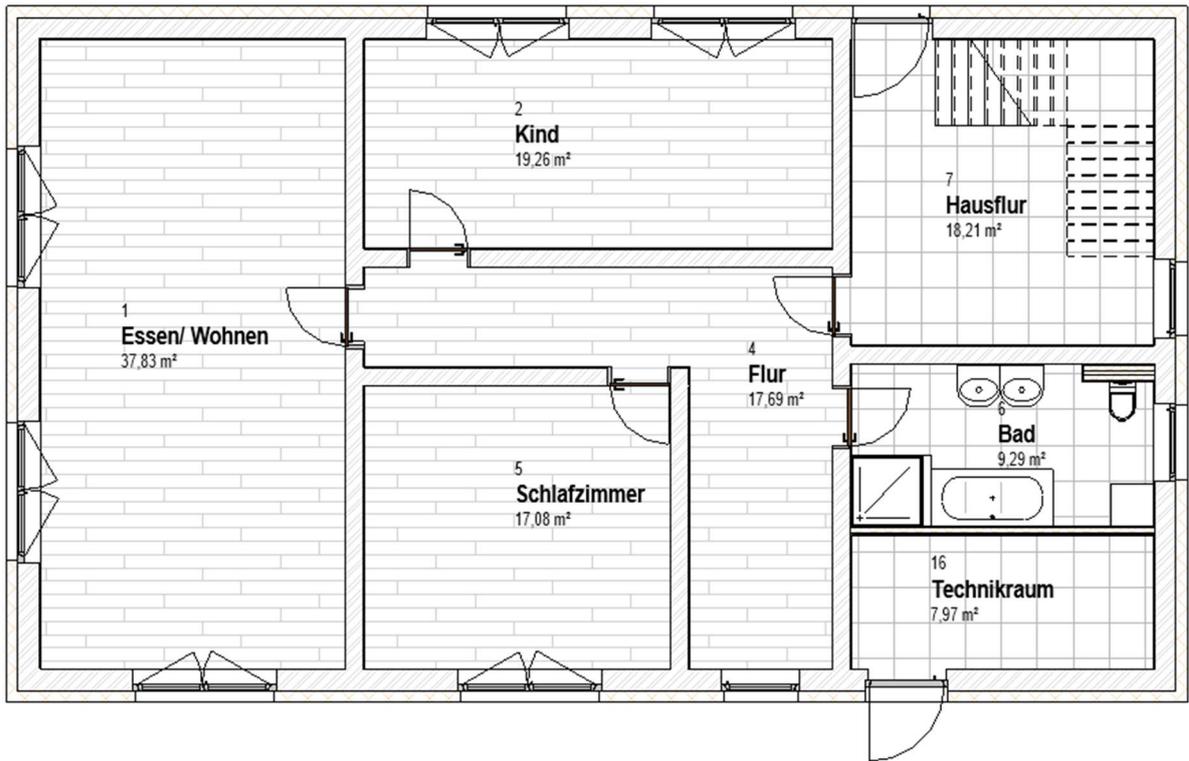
Grundriss des geplanten Erdgeschosses
